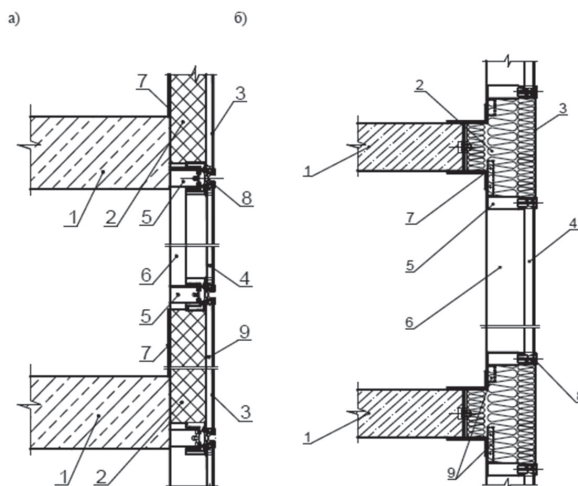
Конструктивна схема зовнішніх стін з комбінованим світлопрозорим фасадом (а) та з суцільним світлопрозорим фасадом з термоізоляцією плит перекриттів (б)
